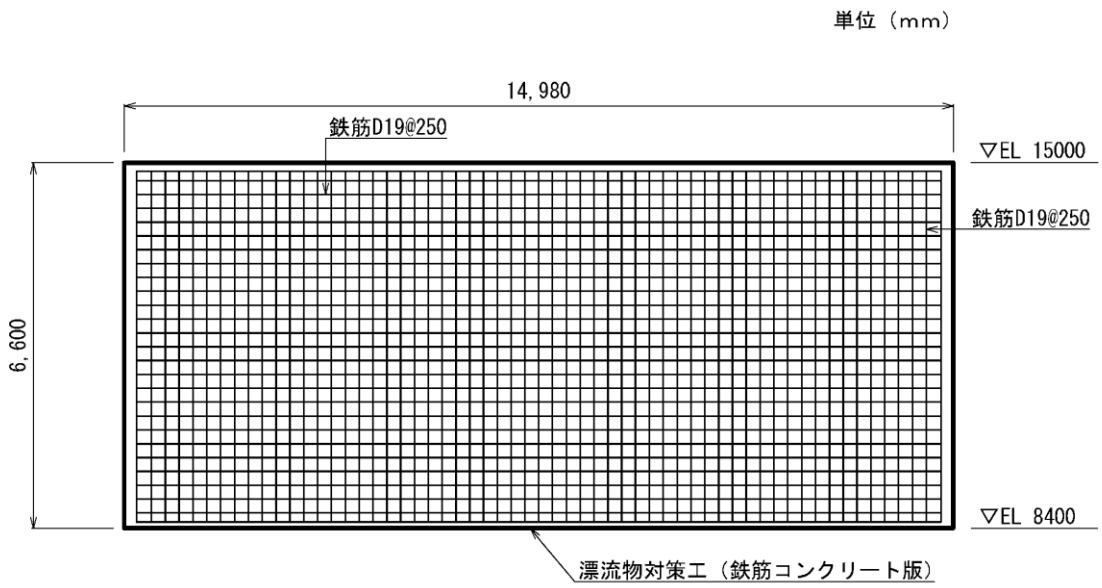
(1) 漂流物対策工 (鉄筋コンクリート版) の概略配筋図 (正面図)
